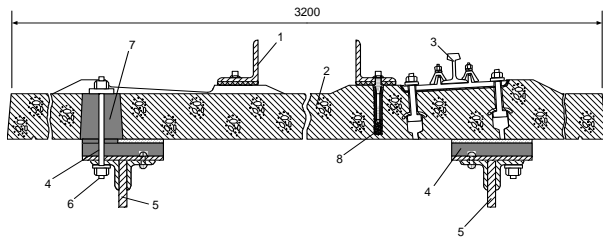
Конструкція мостового полотна на залізобетонних плитах:
